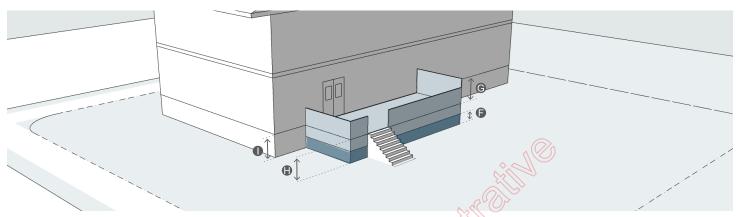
Dépassement de la hauteur d'une terrasse autorisé
